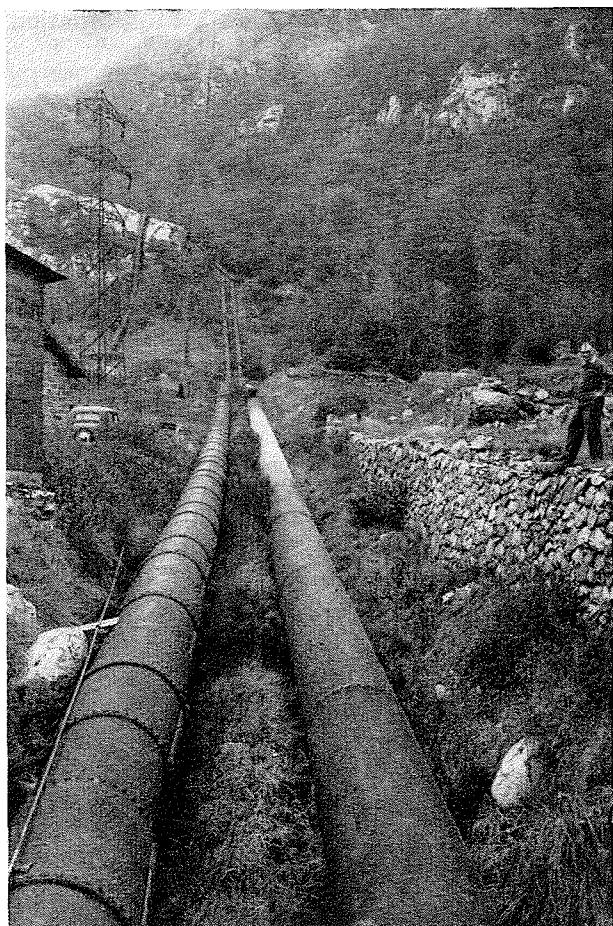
Conduite rivée n° 1. A droite, conduite n° 2, soudée au gaz à l'eau. A gauche, conduite n° 3, soudée à l'arc électrique, à profil rectiligne en plan.
